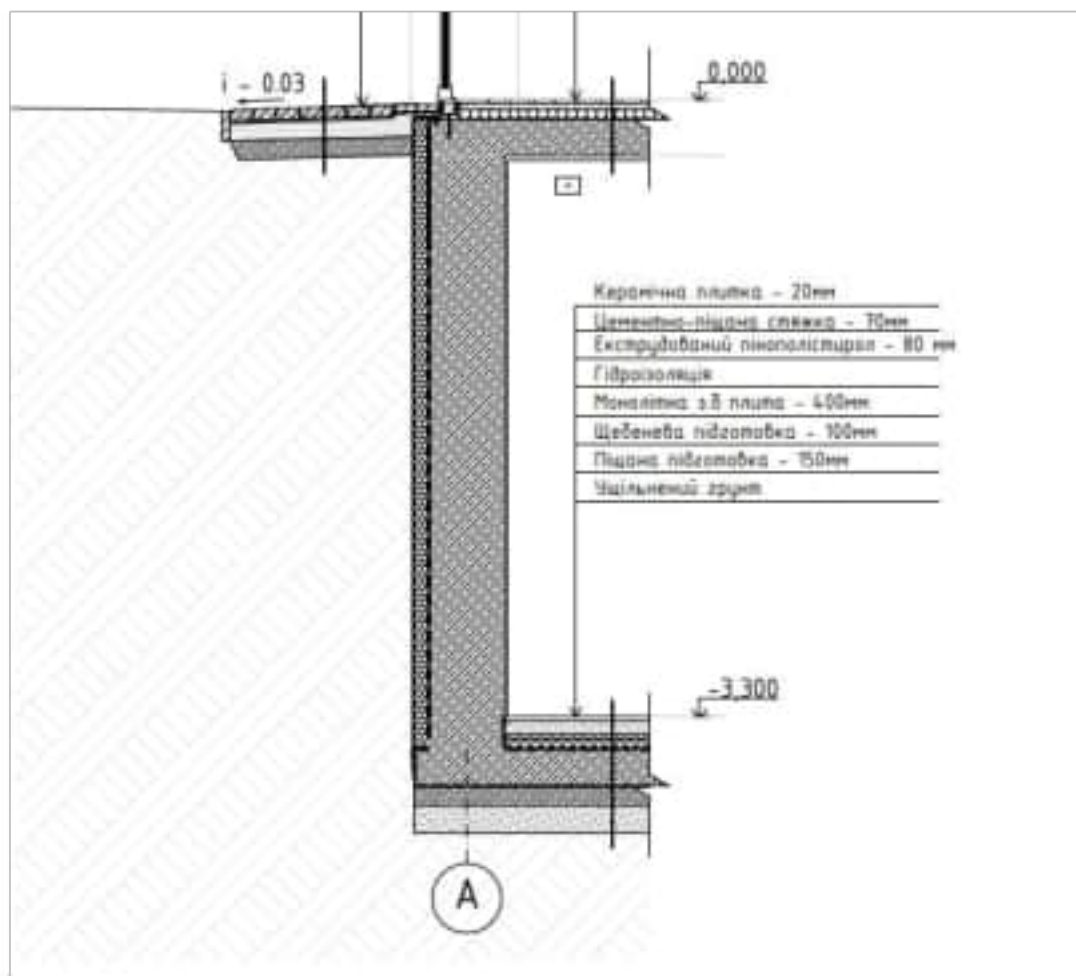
Конструктивний розріз фундаменту будівлі
